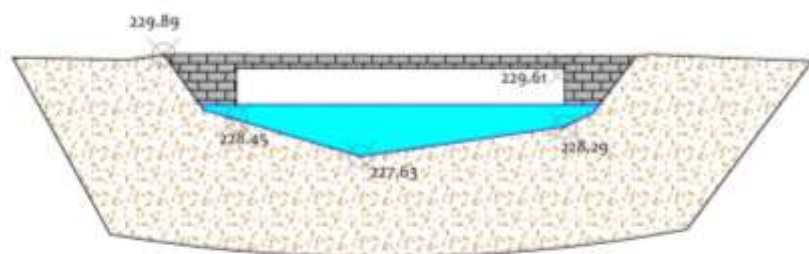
Plan topographique des ouvrages de Villers-le-Temple – Zoom sur la partie aval
